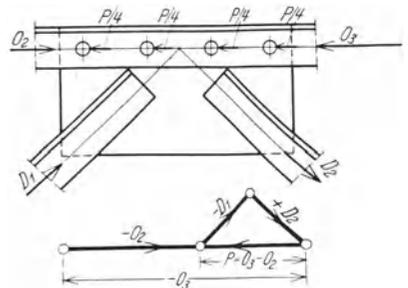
Knoten mit durchlaufendem Gurtstab.
